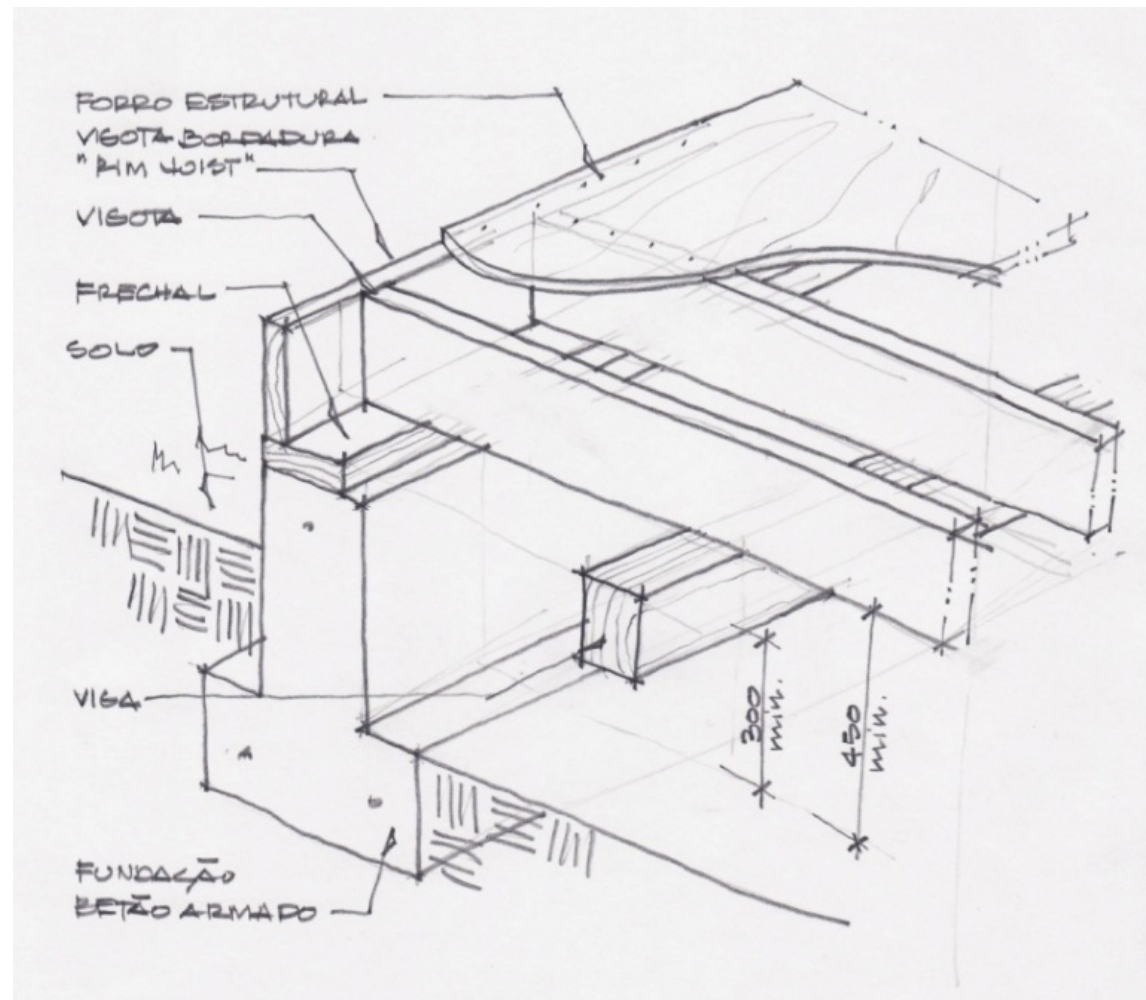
Protecção contra a deterioração da construção através dos afastamentos da madeira ao solo. (des. autor)
